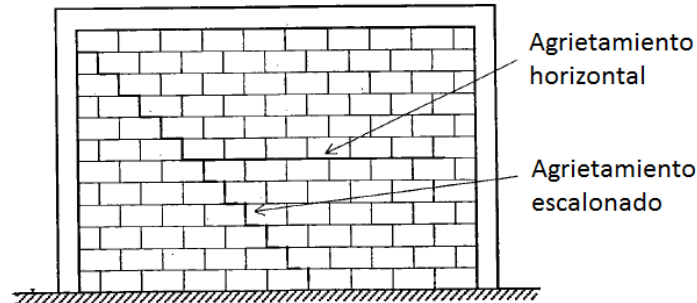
Agrietamiento escalonado y horizontal de la pared de mampostería
